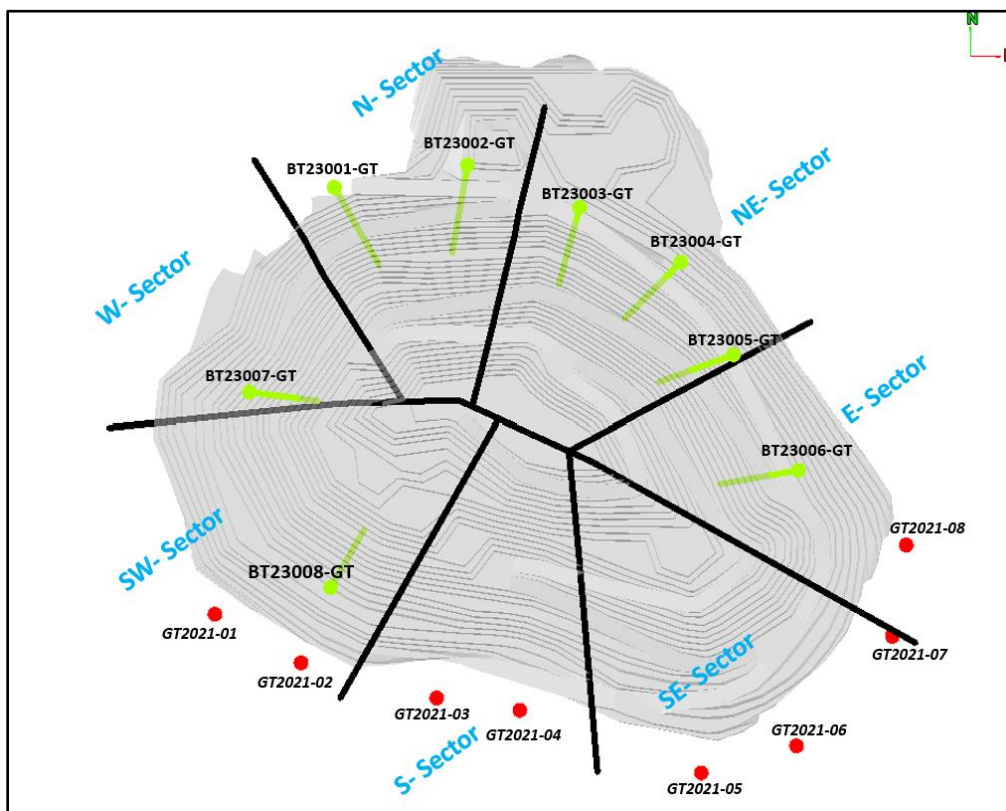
Vista de planta de la proyección de los pozos geotécnicos en la pared sur, oeste y zona norte del pit.
